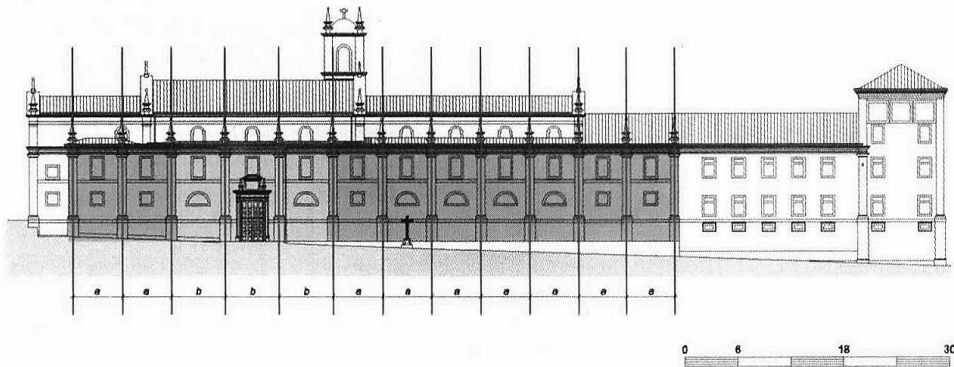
Modulação da fachada da igreja pelo ritmo das pilastras
